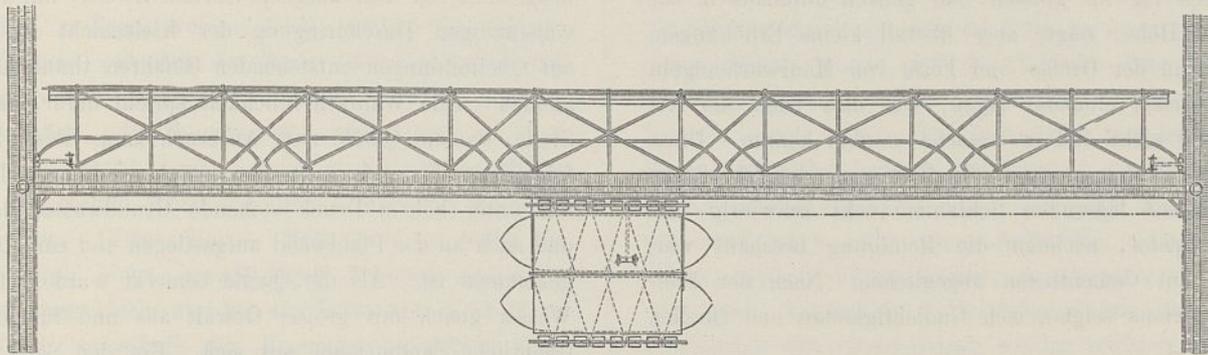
Grundriß der Schwimmbrücke, der anschließenden festen Förderbrücken und des Versenkgerüsts.
